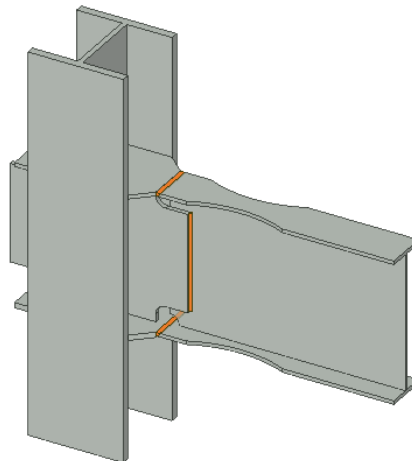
Dimensiones de la zona reducida de la viga para conexión RBS-W.
